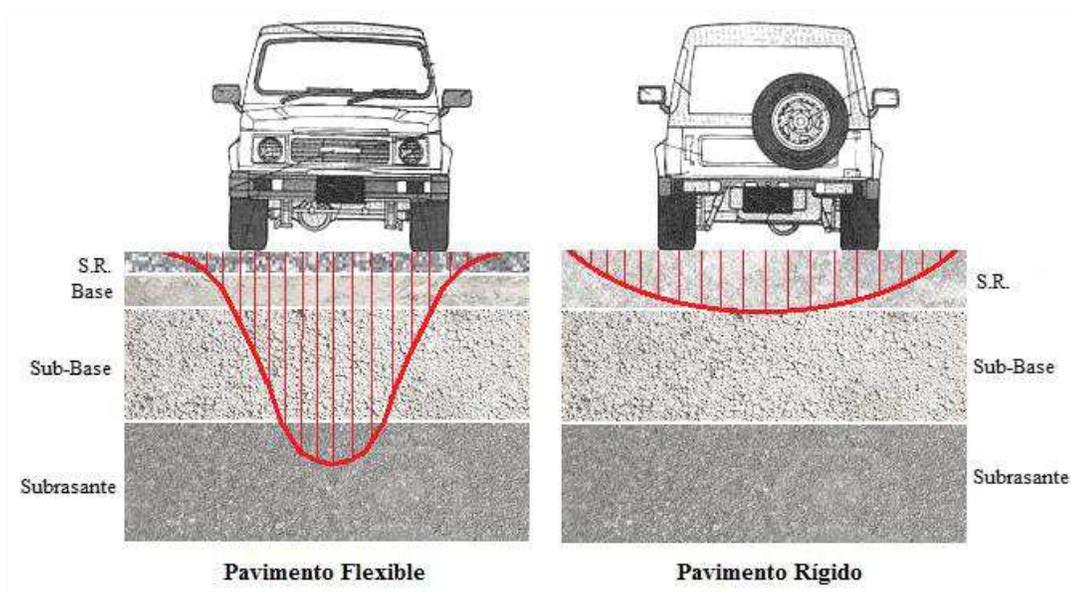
Comparación comportamiento estructural de los pavimentos rígidos y asfálticos.
